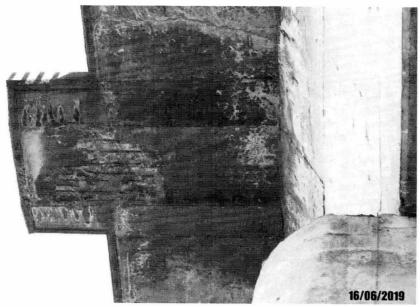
Detalhe de armadura exposta na face inferior do tabuleiro, lateral da viga principal e fissura na face inferior do tabuleiro.
